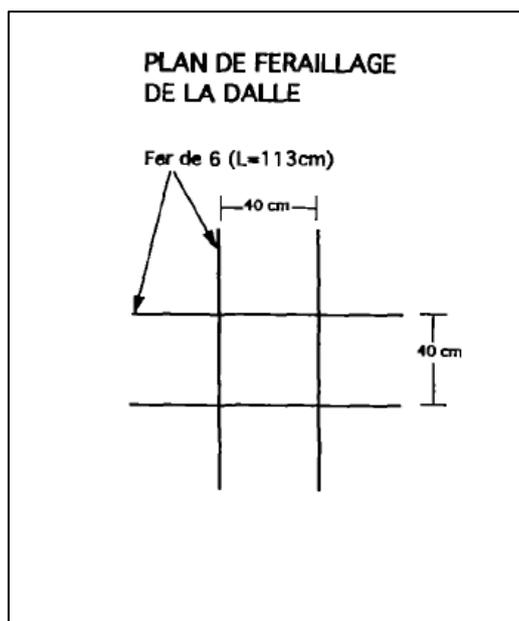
Plan de ferrailage de la dalle SANPLAT (EAA, 1996)
